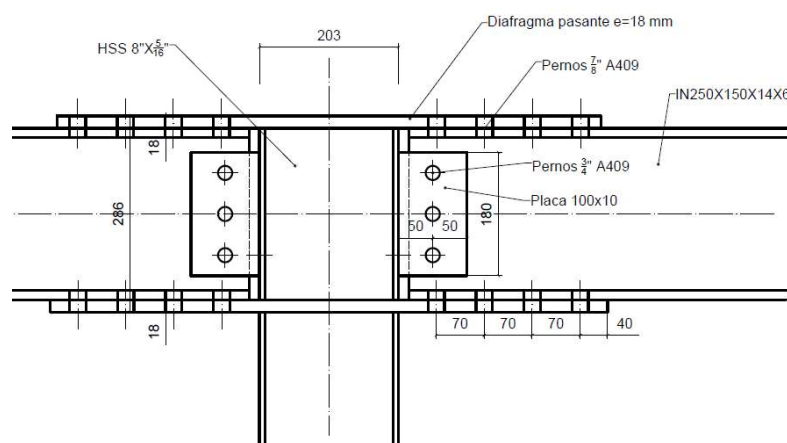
12- Detalle conexión viga-columna edificio P₁,L₁,Z₂.
